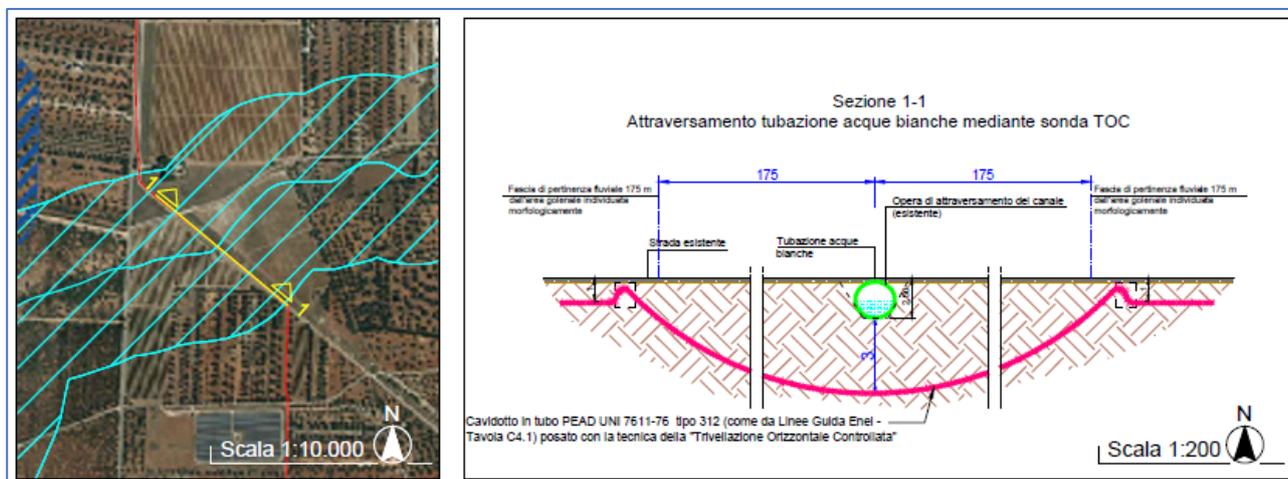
Stralcio studio degli attraversamenti – TAB-CIV-TAV-017\_00 – Studio degli attraversamenti
